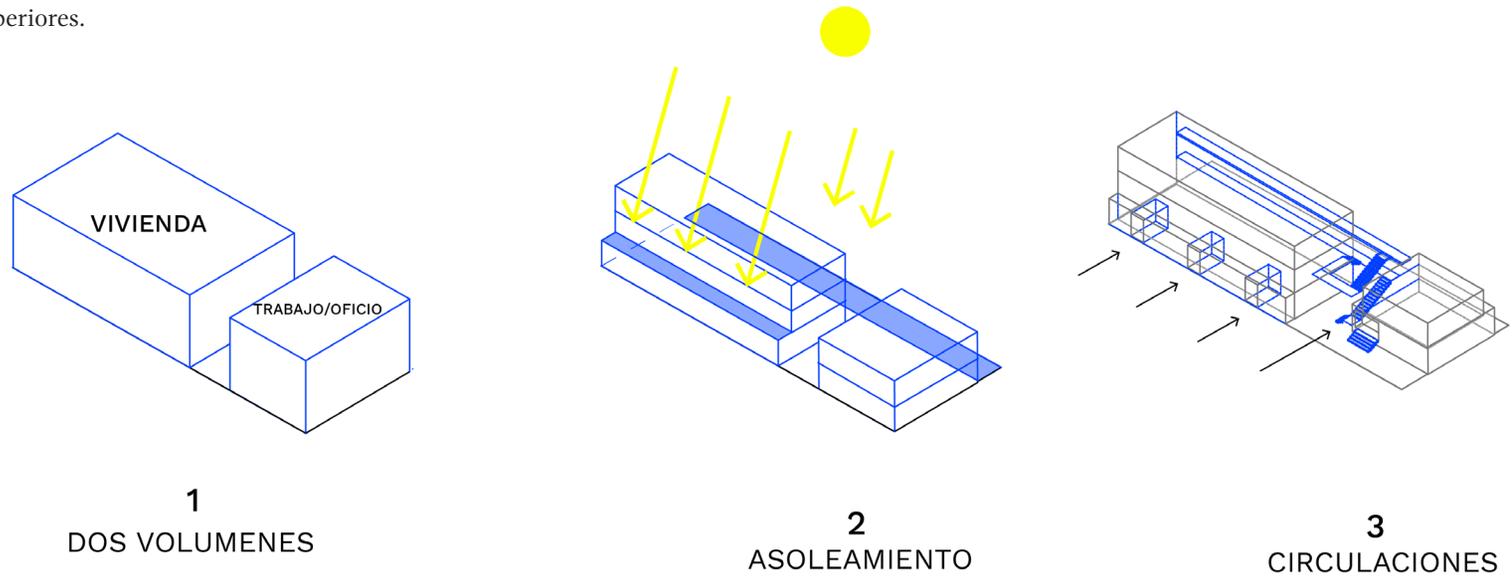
Operaciones volumétricas vivienda en el pasaje. Elaboración propia
